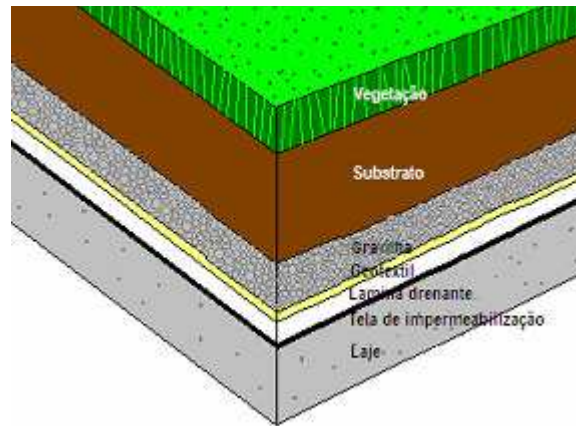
Camadas que devem constar na construção de jardins na cobertura de uma edificação.
